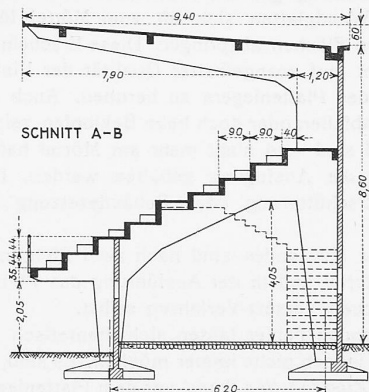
Grundrisse 1 : 400; Abb. 2 Schnitt 1 : 200 der Zuschauer-Tribüne für die Pferderennen in Yverdon.
